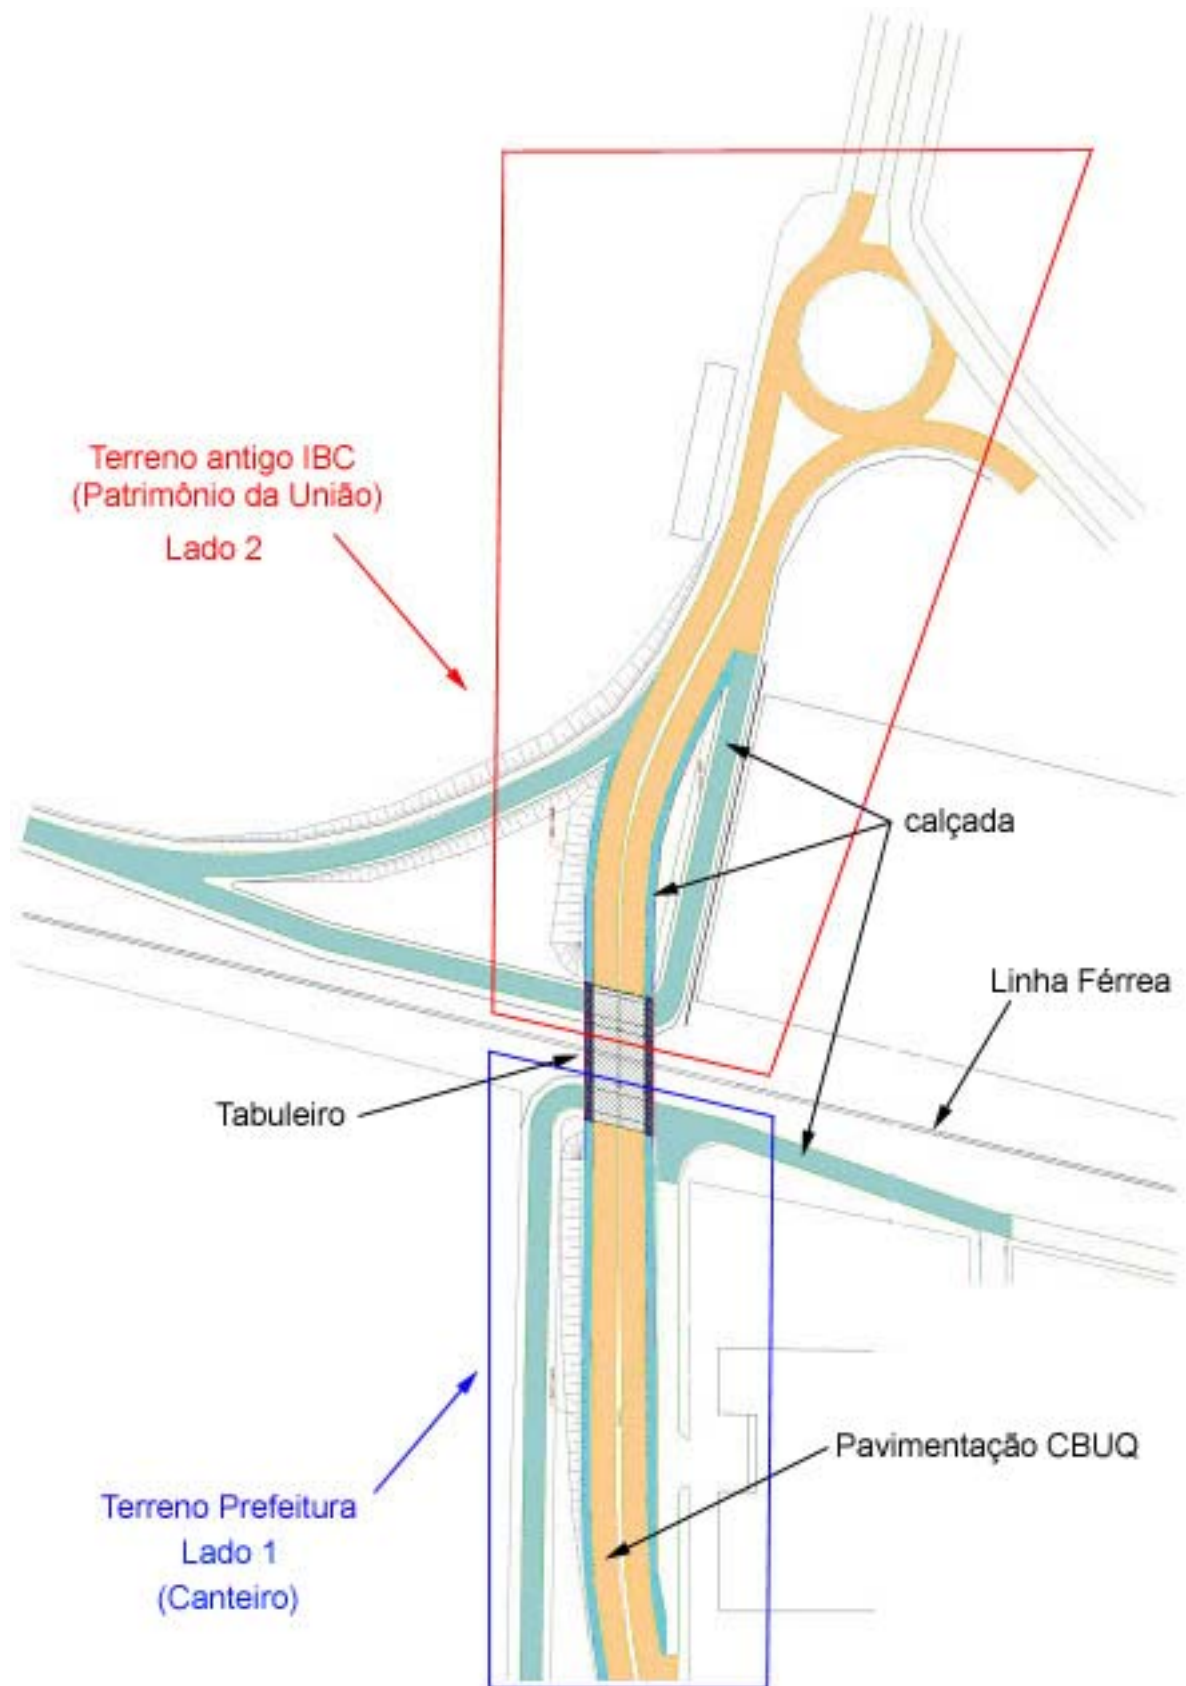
Planta de Situação do Viaduto Centenário
